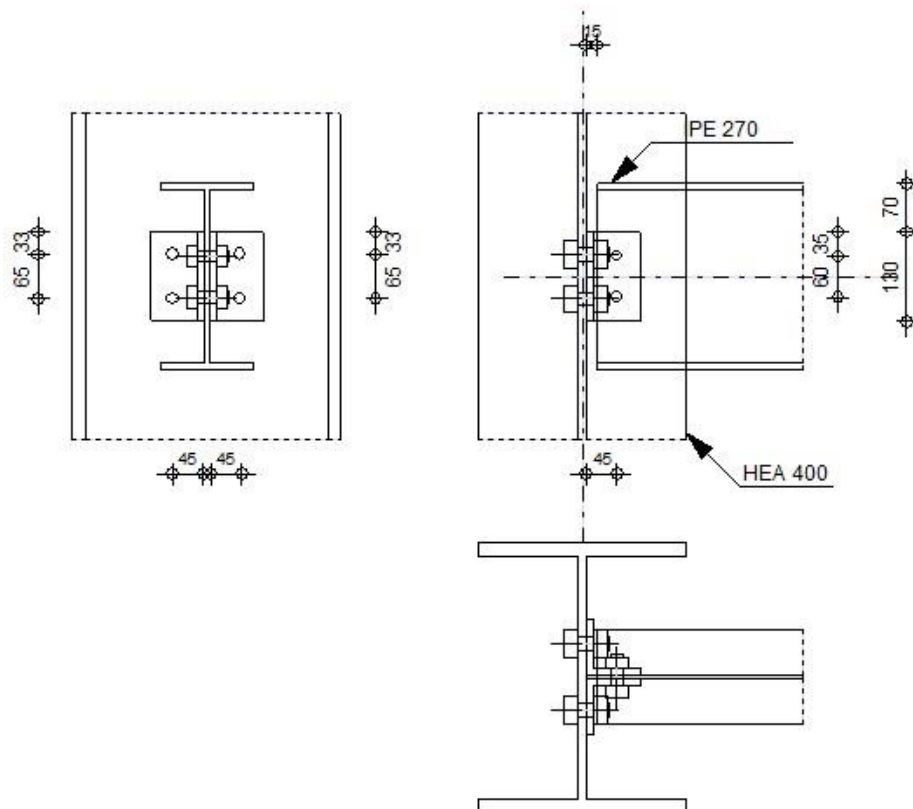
Détail sur l'assemblage poteau-poutre maitresse
